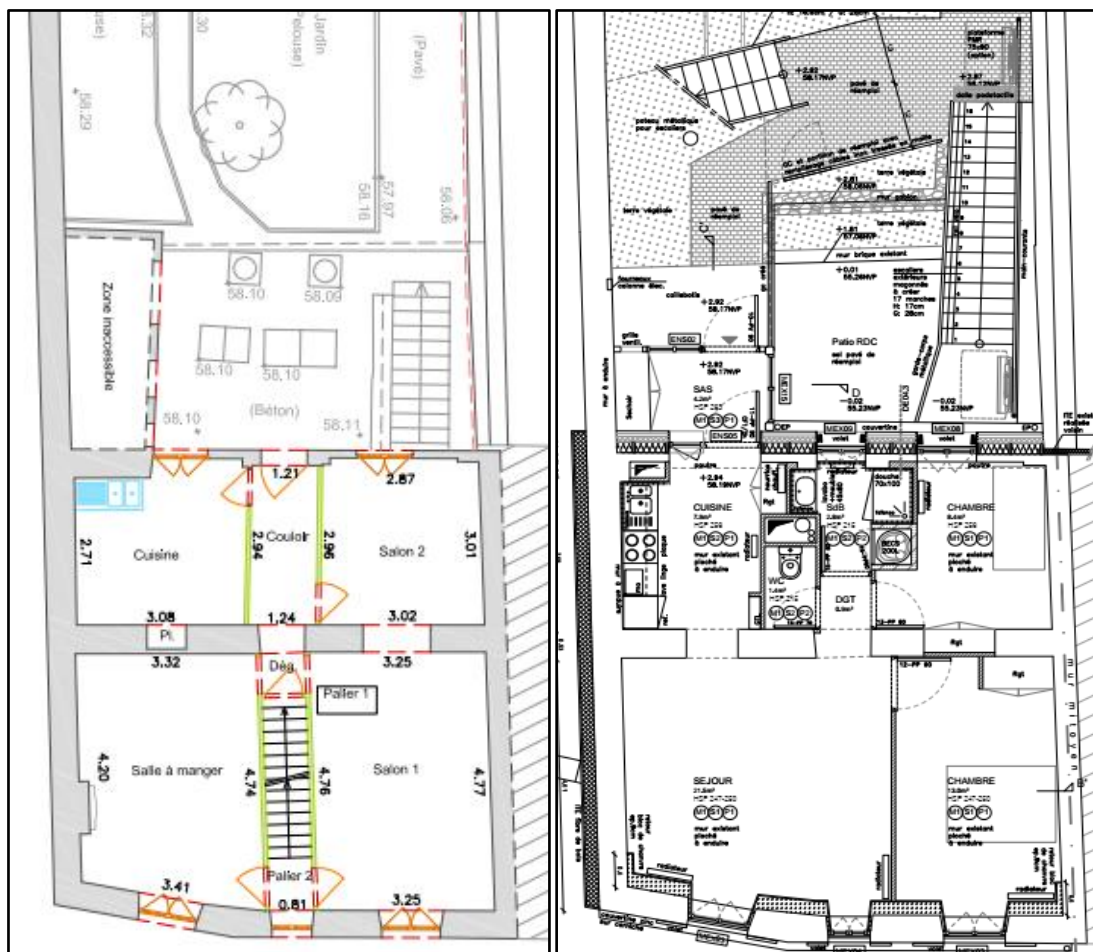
Plan du R+1, état existant à gauche et état projeté à droite
